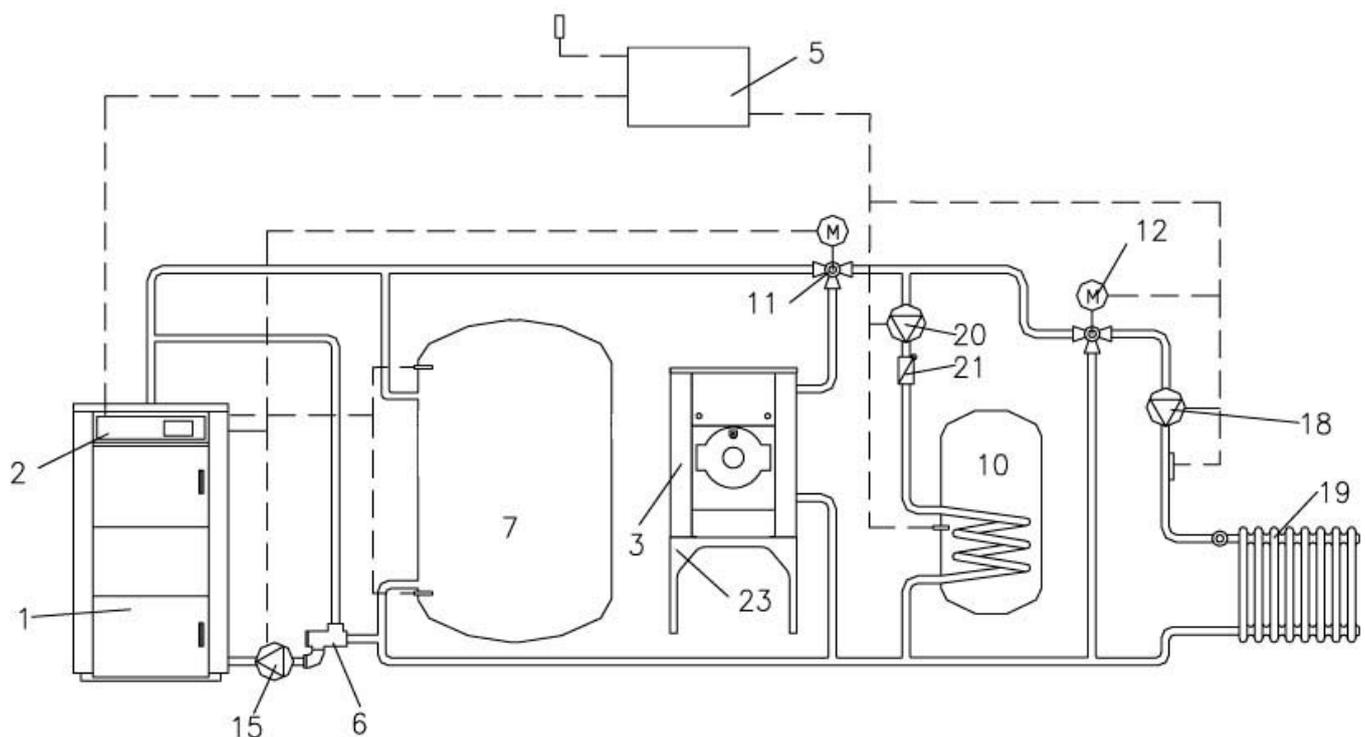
Anlagenvorschlag F Bild 1: Holz-Öl-Heizungsanlage mit nebenstehendem Ölkessel und separatem Boiler
